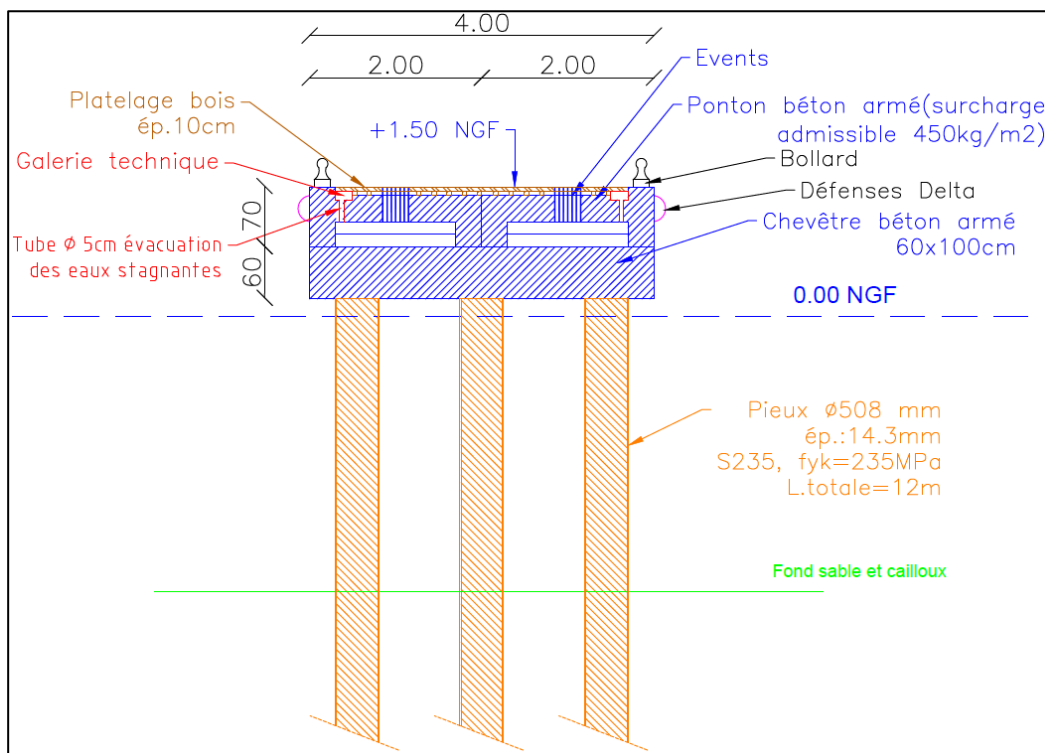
Nartelle centre – Aménagement appontement sur pieux – Coupe type transversale seconde partie du ponton (côté large – P2)
